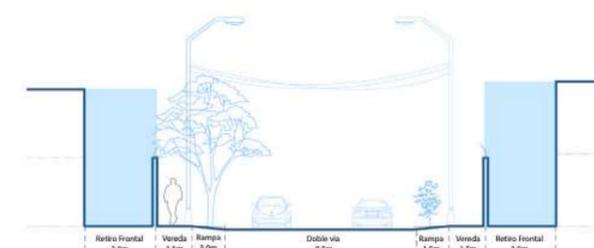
Sección 1 - 1 (Calle Pedro Ventura)
